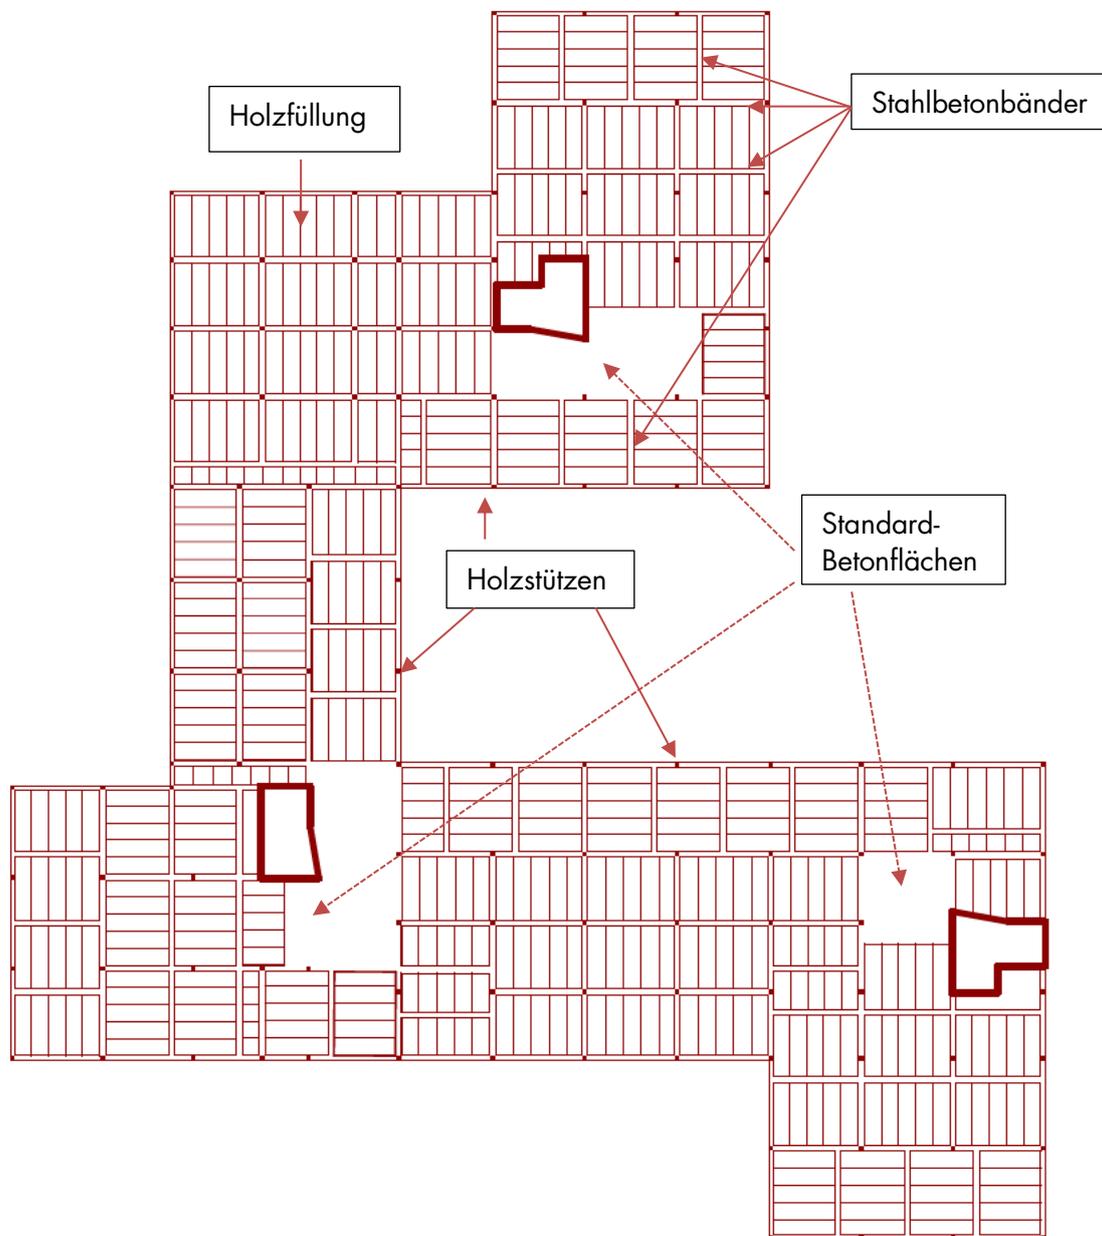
Layout eines Regelgrundrisses (das Obergeschoss)
